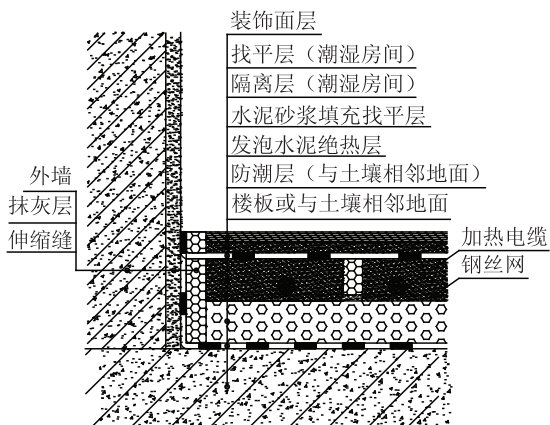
混凝土填充式加热电缆供暖地面构造 (二)
